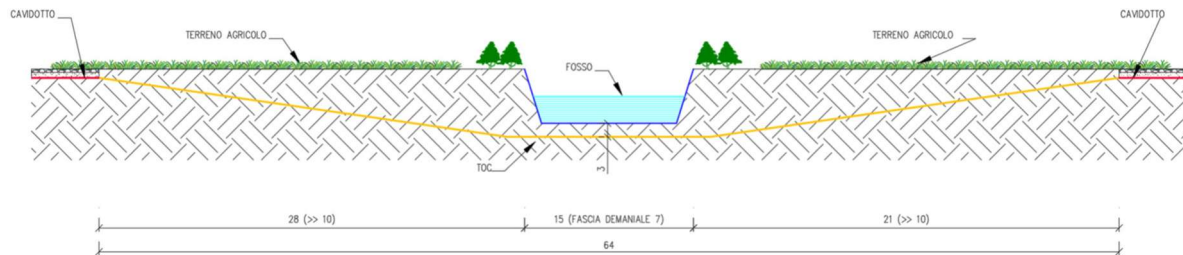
Sezione tipo attraversamento mediante T.O.C.
